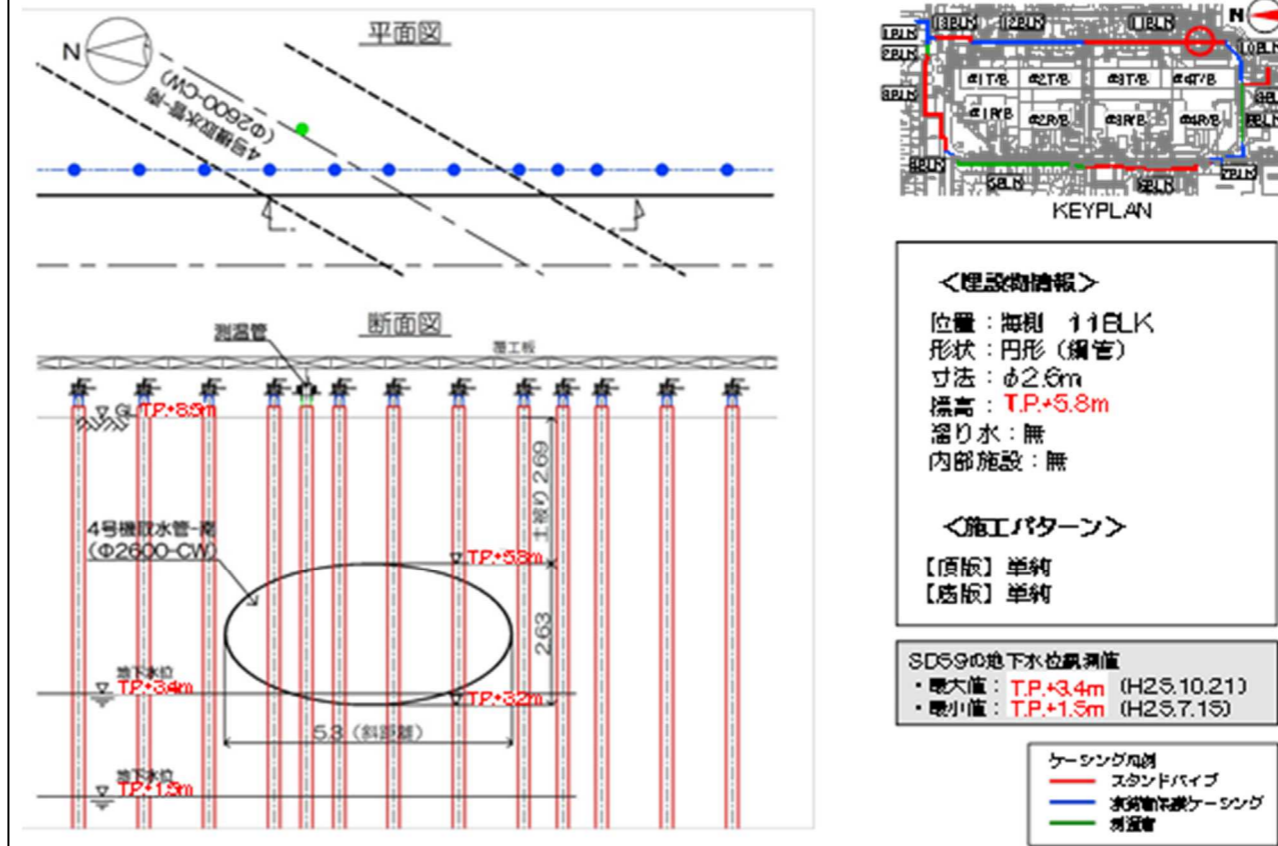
【11-1】4号機取水管-南 施工方法(貫通施工)
